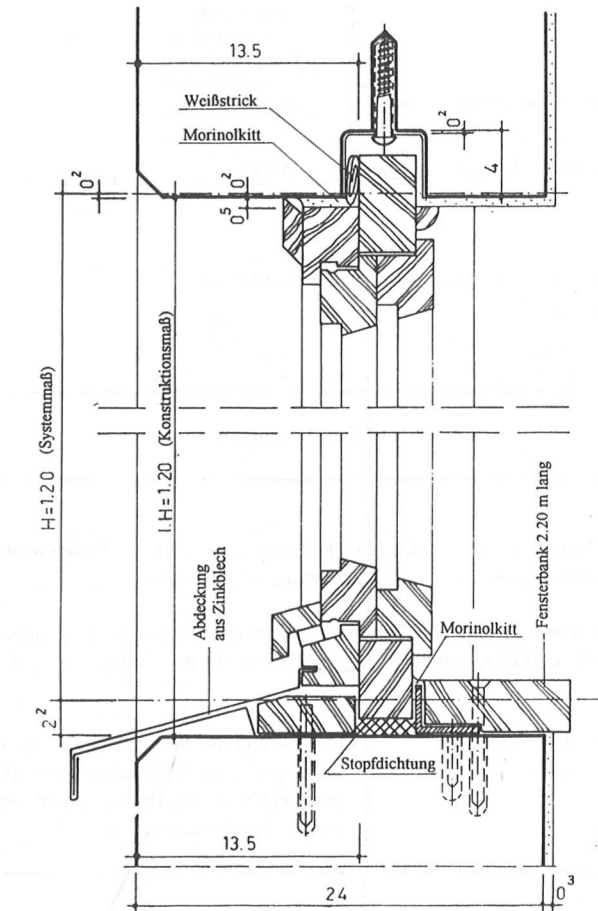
Fensteranschluß bei Außenwänden aus Porenbeton Vertikalschnitt
